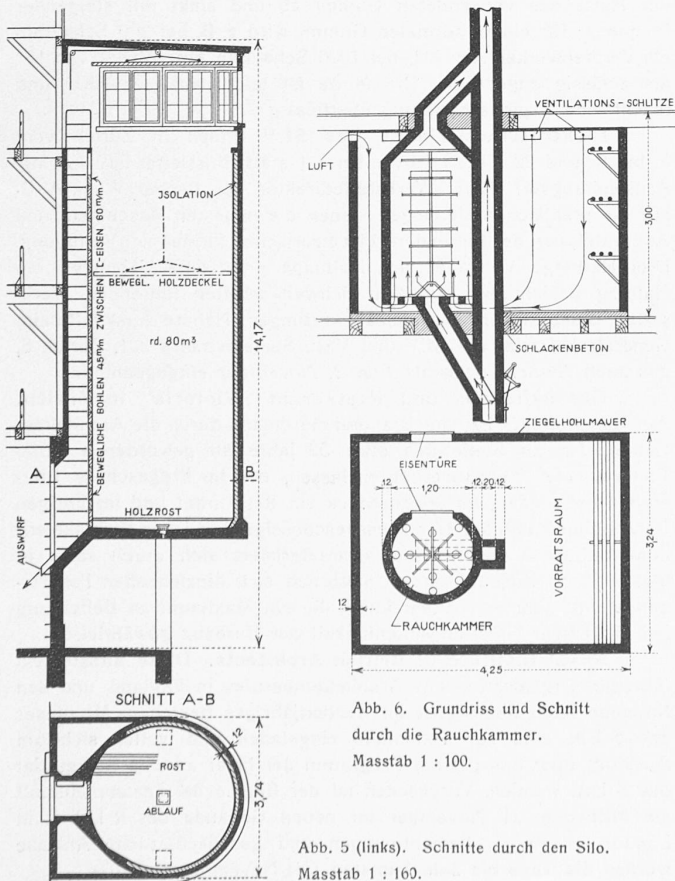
Grundriss und Schnitt durch die Rauchkammer. Masstab 1 : 100.
